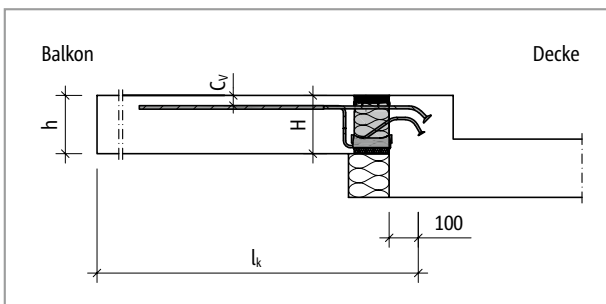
Schöck Isokorb® XT Typ K-O: Statisches System
